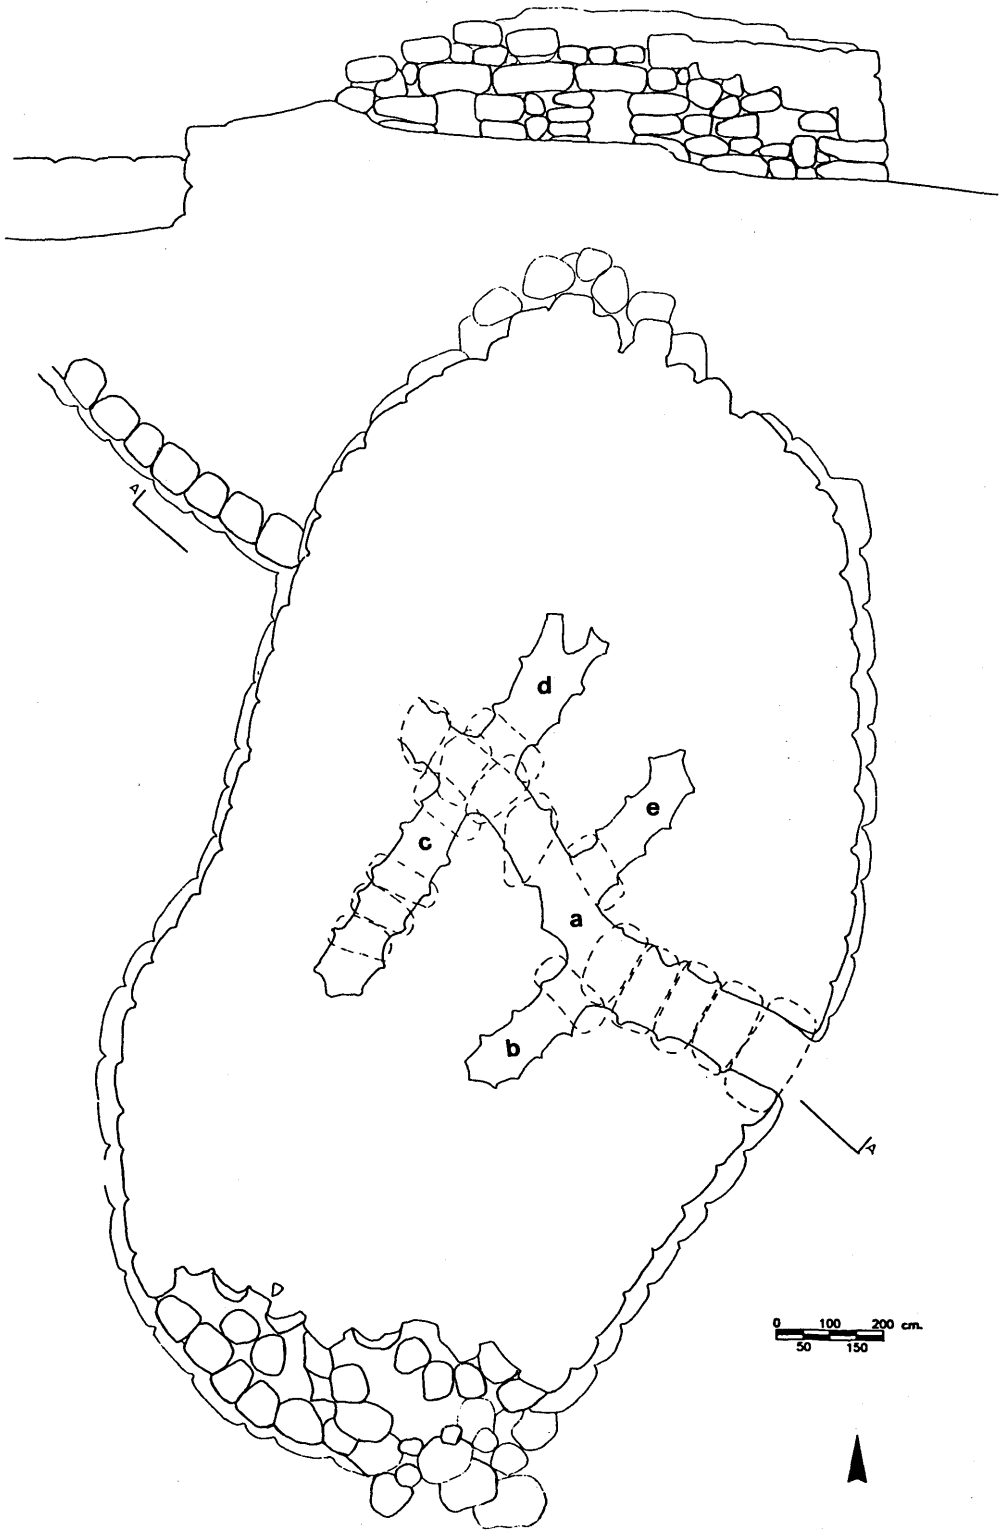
Nuraghe Sa Madalena: sezione e planimetria.
